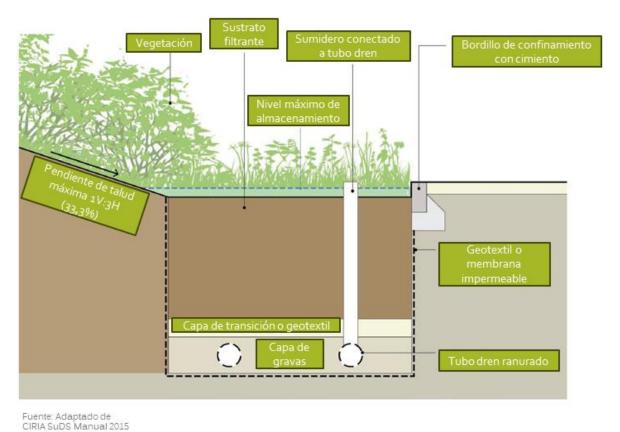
Sección tipo de un parterre inundable con sumidero conectado a tubo dren.
